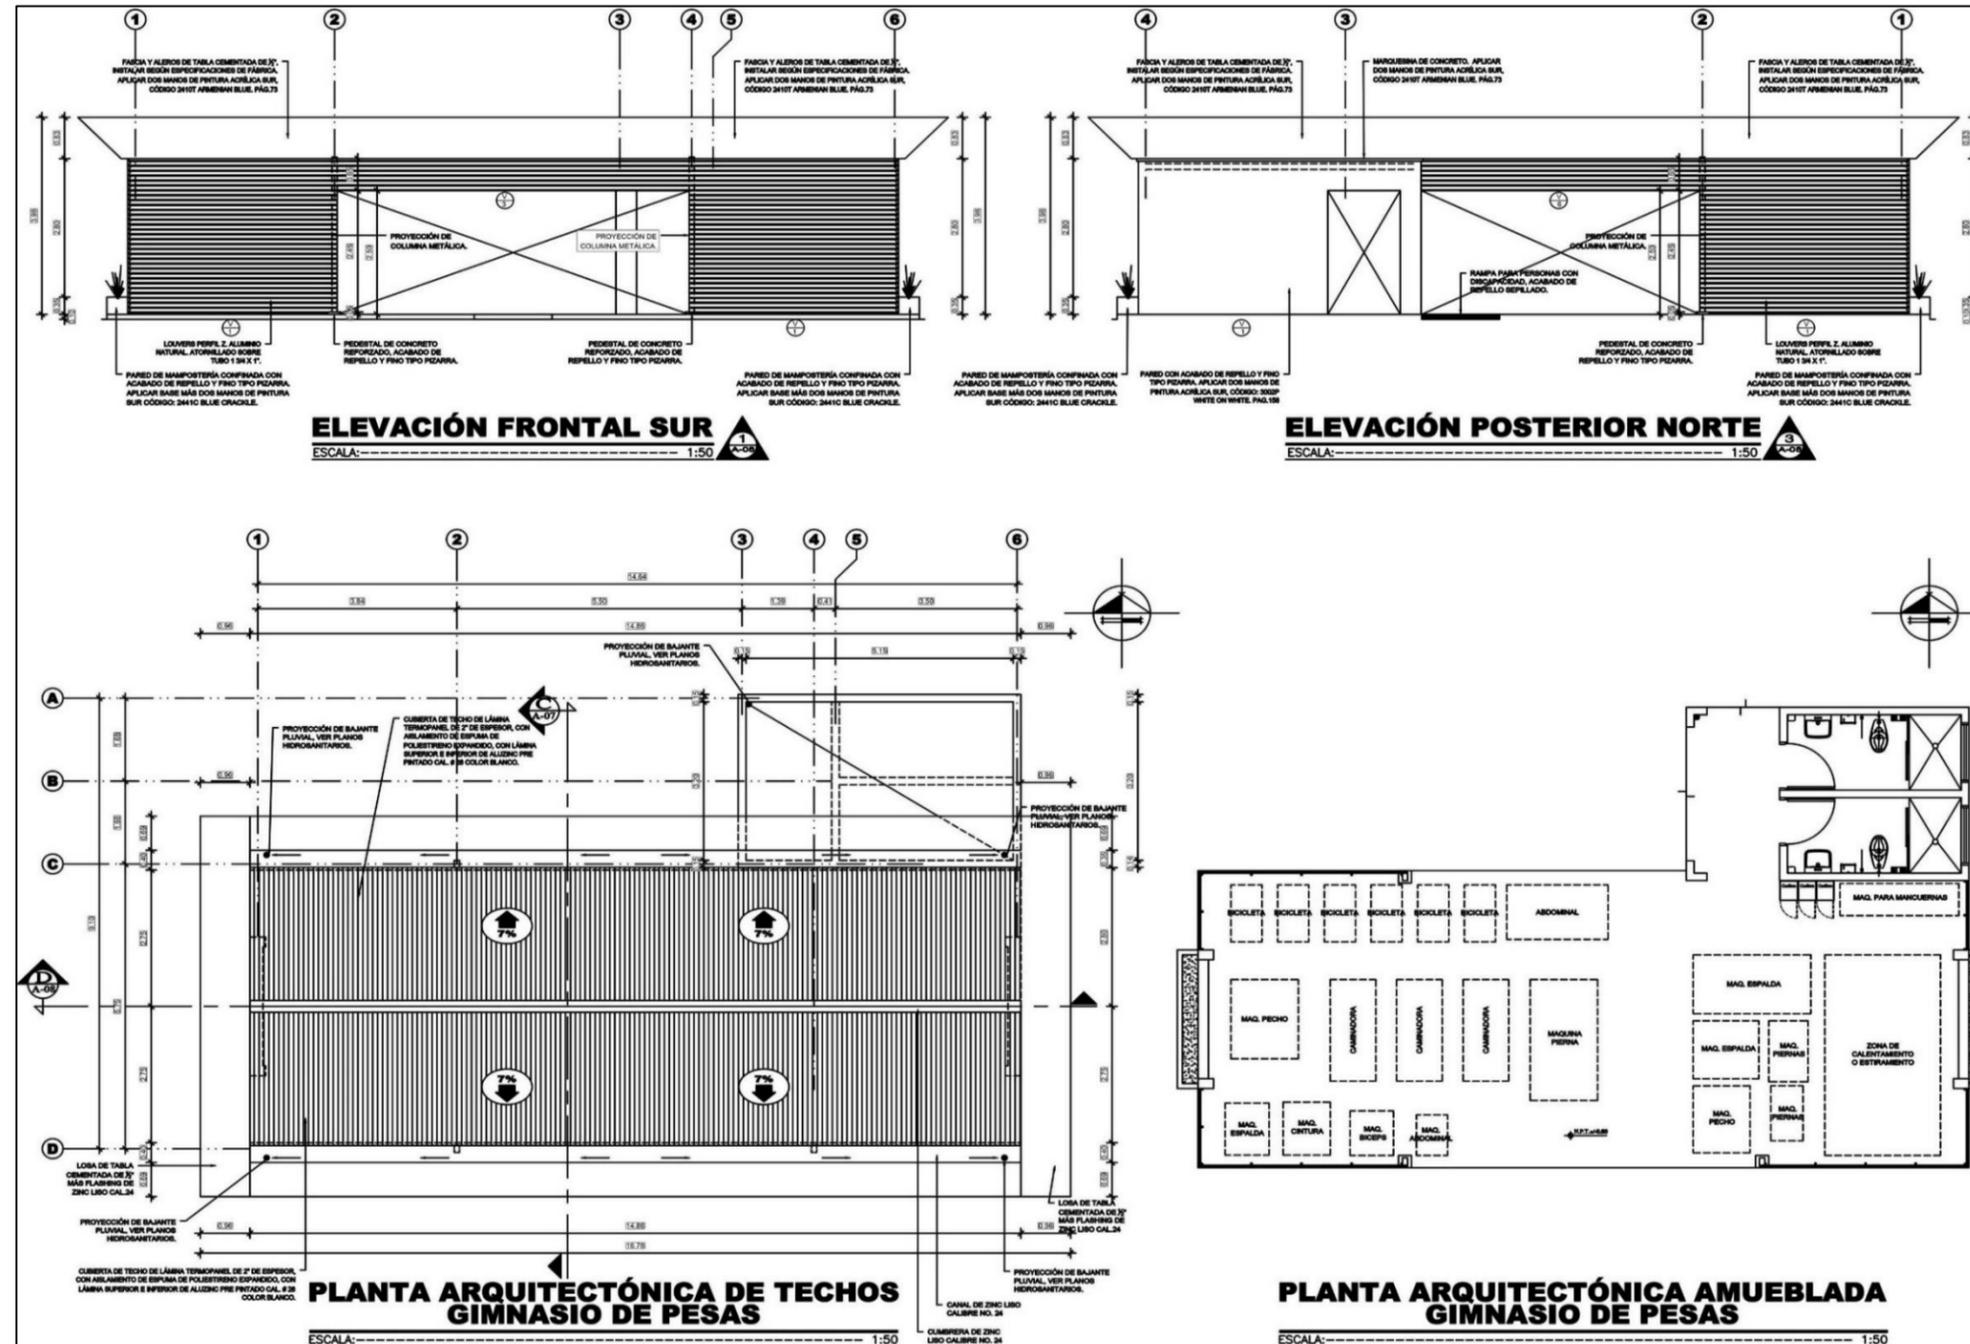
Planta Amueblada, Planta de Techo y Elevaciones del Gimnasio de pesas
